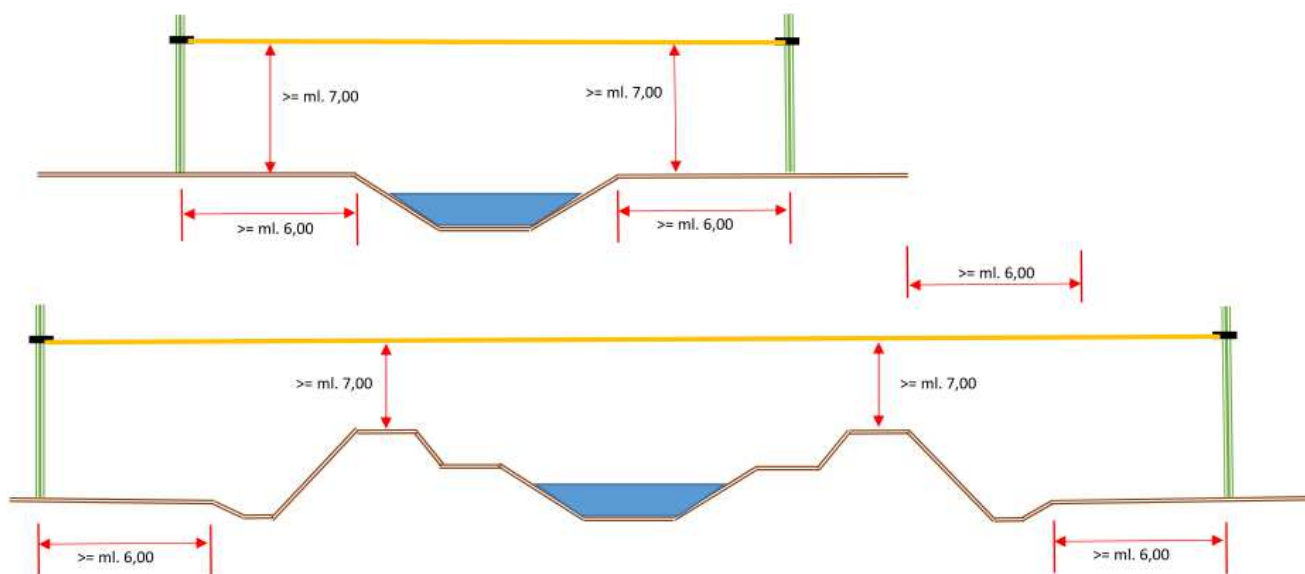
Attraversamenti aerei con cavidotti e elettrodotti
